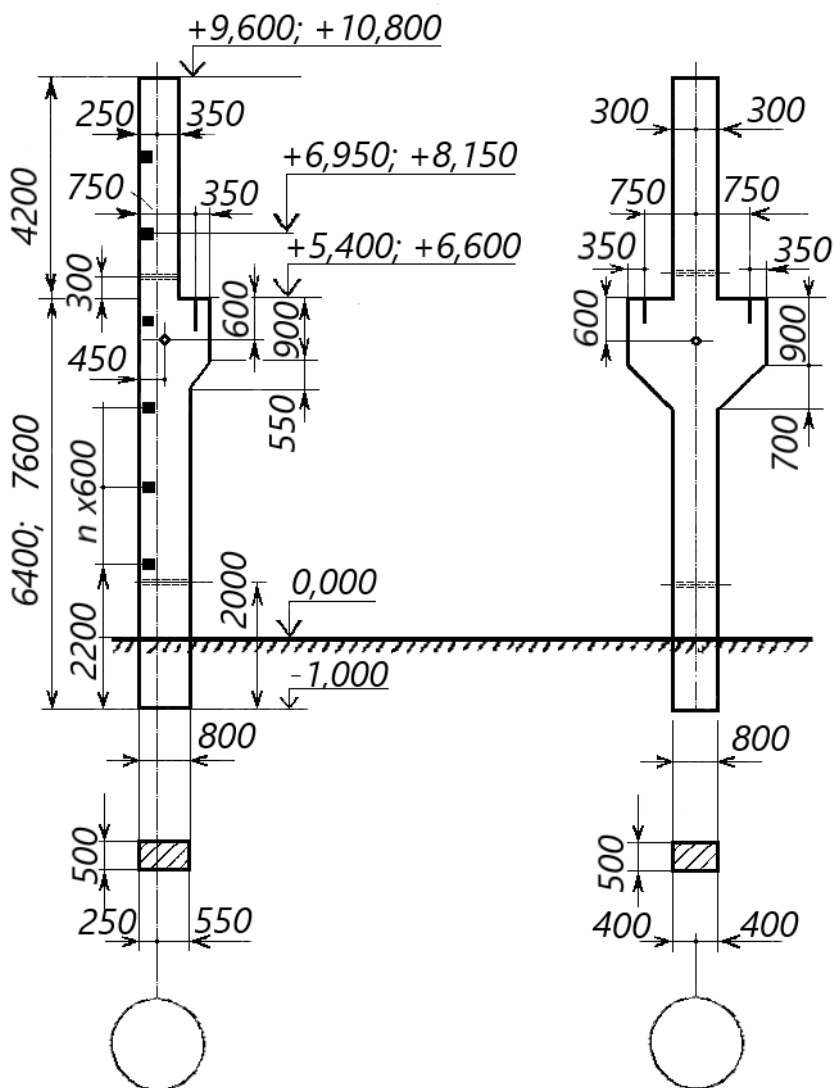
Типові колони для будівель висотою 9,6 м або 10,8 м з кранами вантажністю 100 кН або 200/50 кН, прольотами 18 м або 24 м, з кроком колон 12 м
